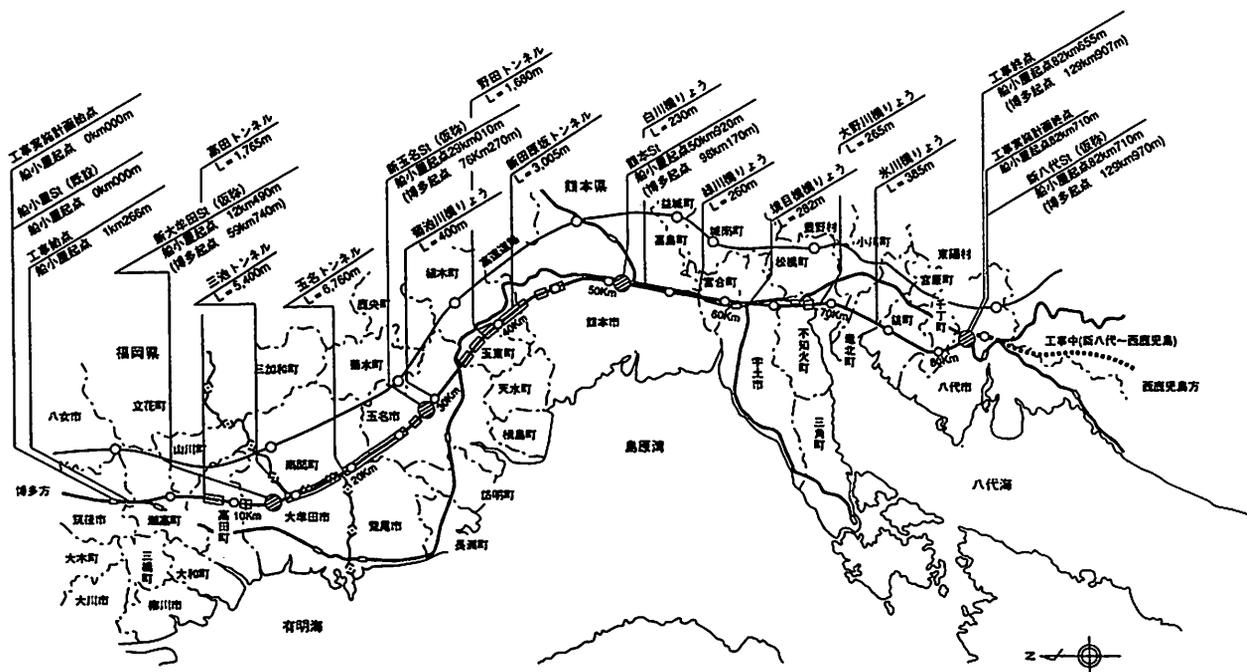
九州新幹線新船小屋・新八代（仮称）間線路平面図
